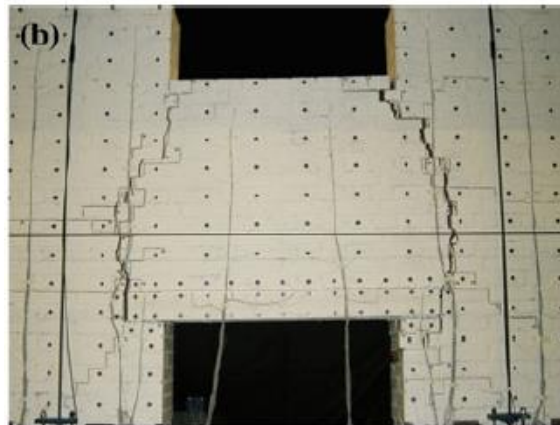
Patrón de agrietamiento después de la fisuración, grietas de flexión a través de las juntas y ladrillos (Katrin Beyer & Dazio, 2012).
